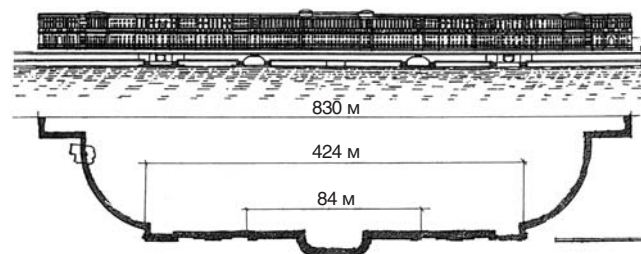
Схематическое изображение фасада Кремлевского дворца В.И. Баженова со стороны набережной Москвы-реки [1]
